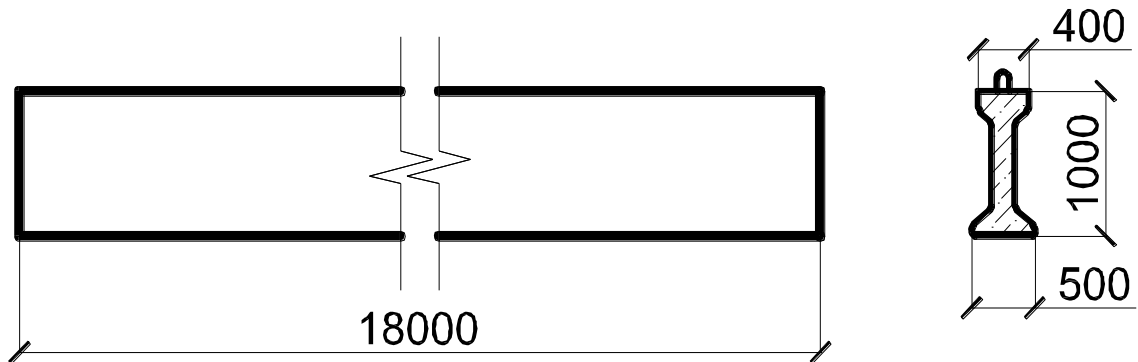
Попередньо напружена залізобетонна балка 18 м
